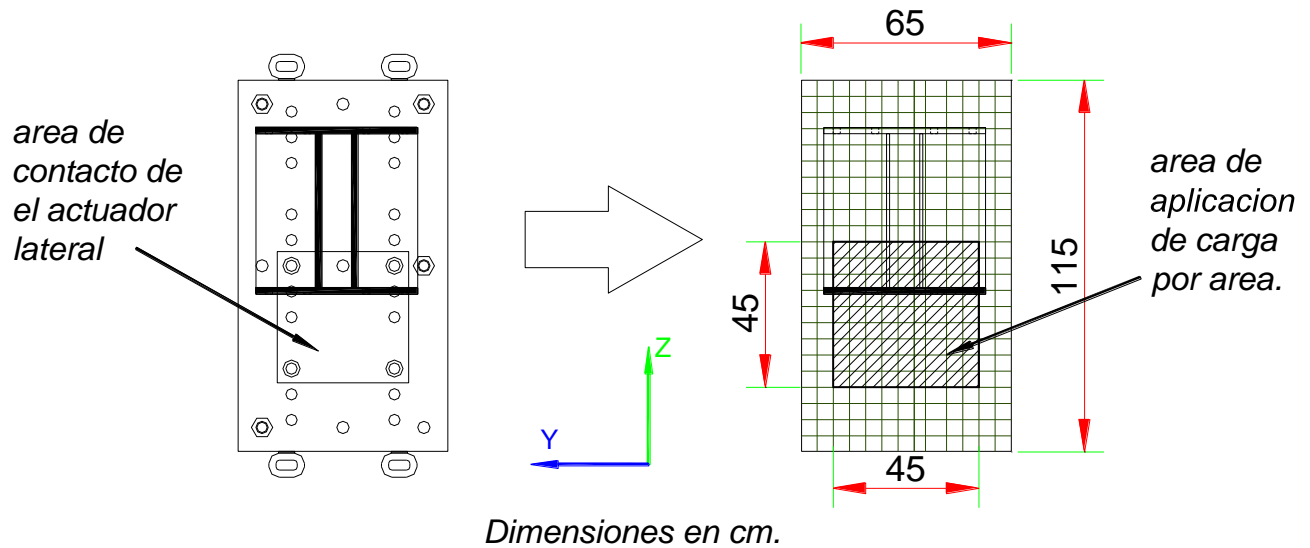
Zona de aplicación de carga en la placa de pretensado de la viga de transmisión.
